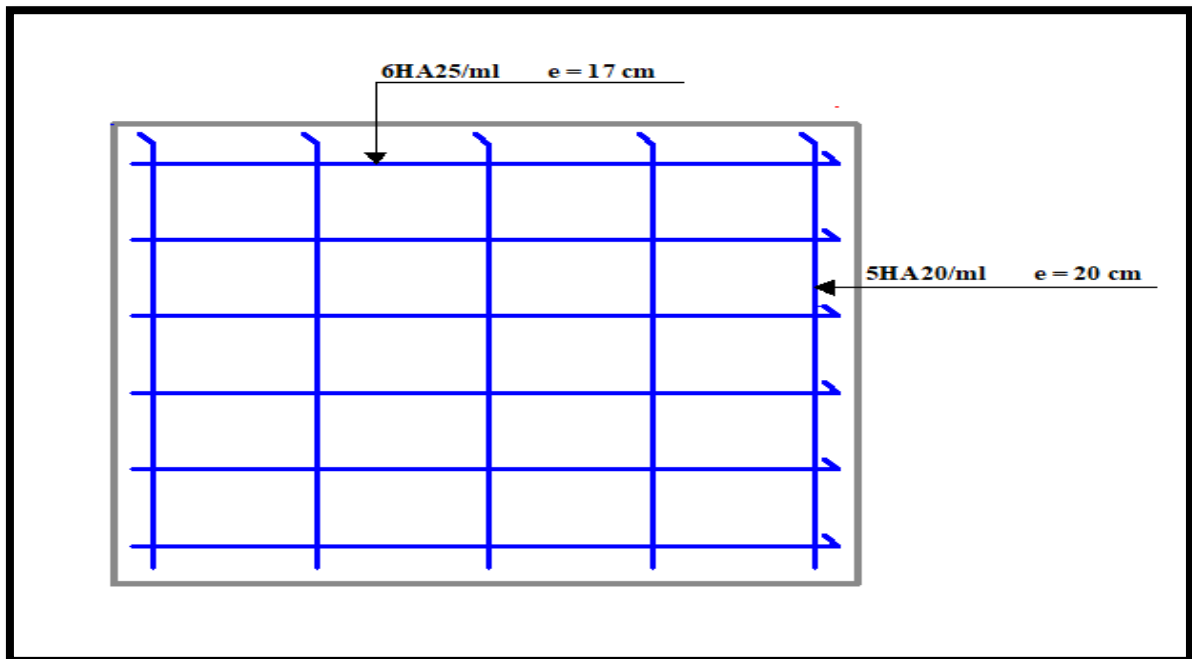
Ferrailage de la nappe inférieure du radier
